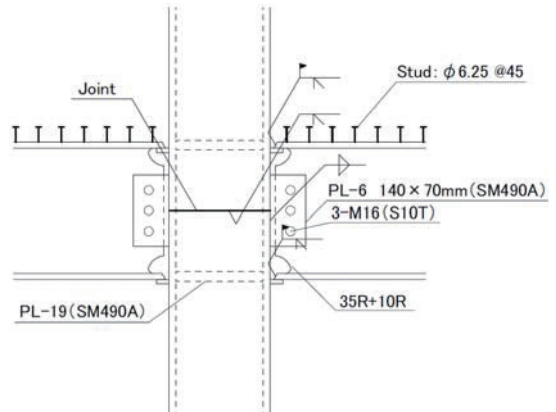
柱梁接合部の概要 (2～7F) (Beam to Column Connection(2-7F))
